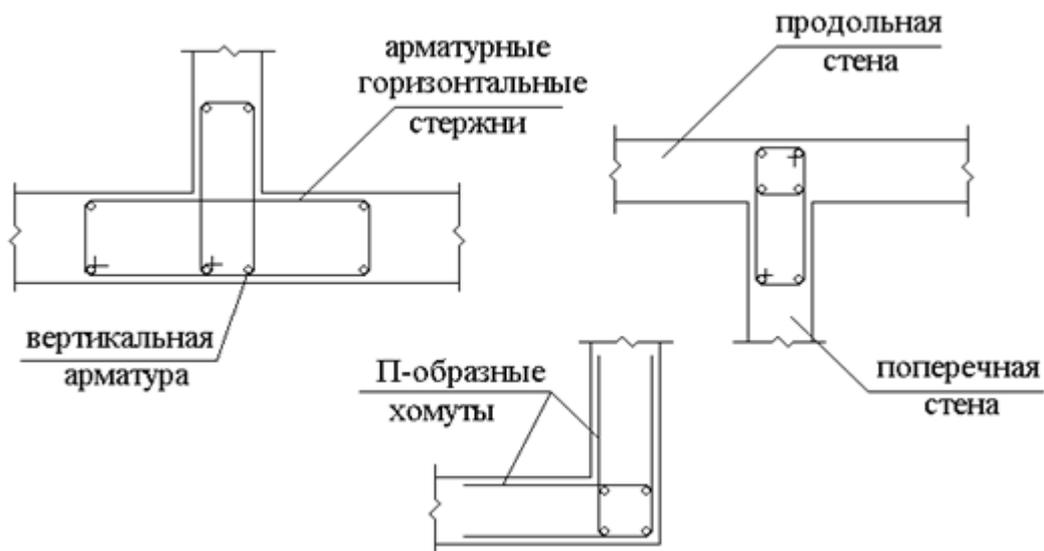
Схема армирования зоны контакта продольных и поперечных стен.
